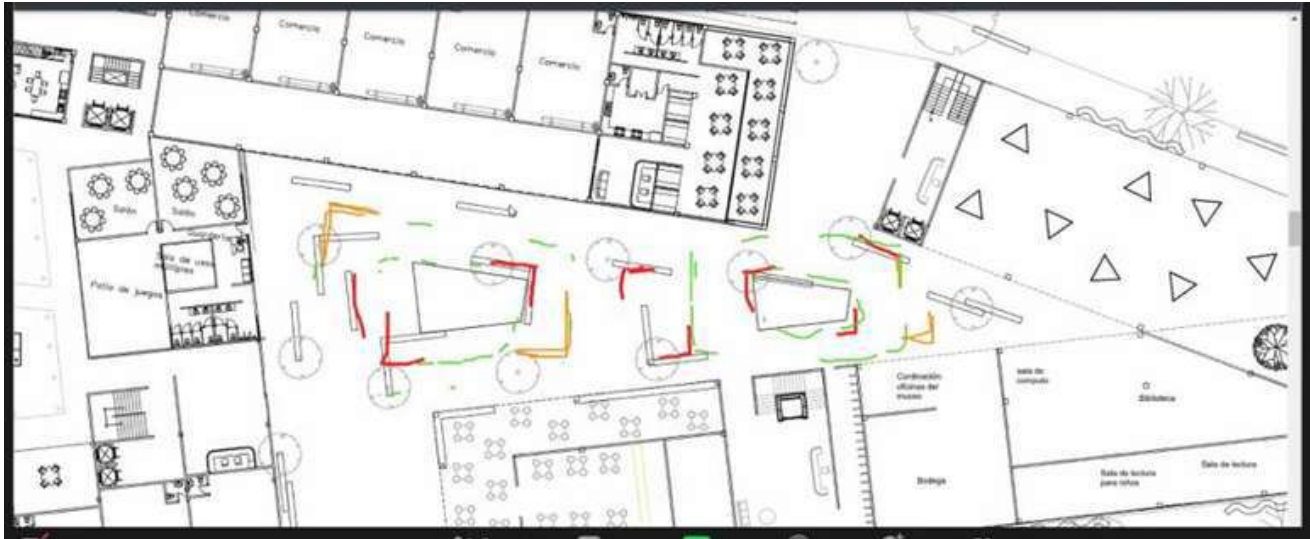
Planta arquitectónica con análisis. Fuente: Autoría propia
